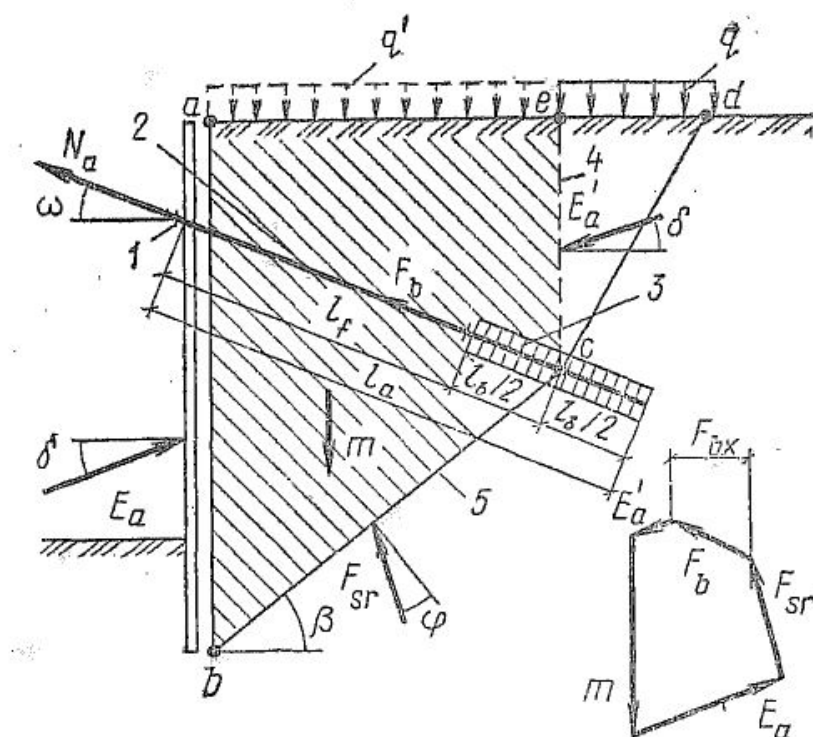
К определению устойчивости системы «стена - грунт - анкер»
